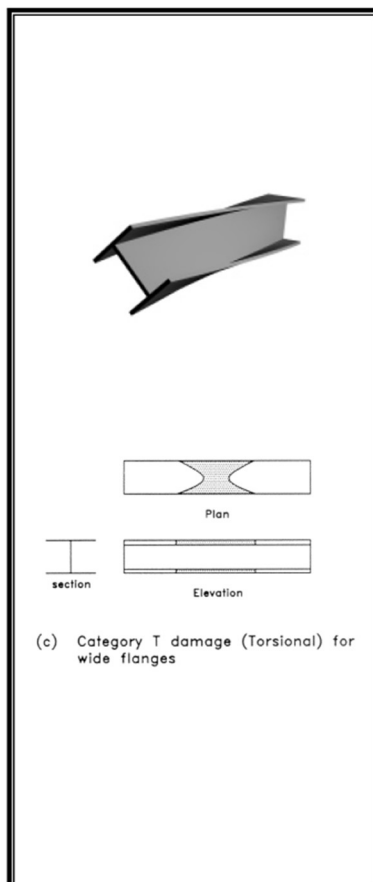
Elemento sujeito a torção (FHWA, 2008)
